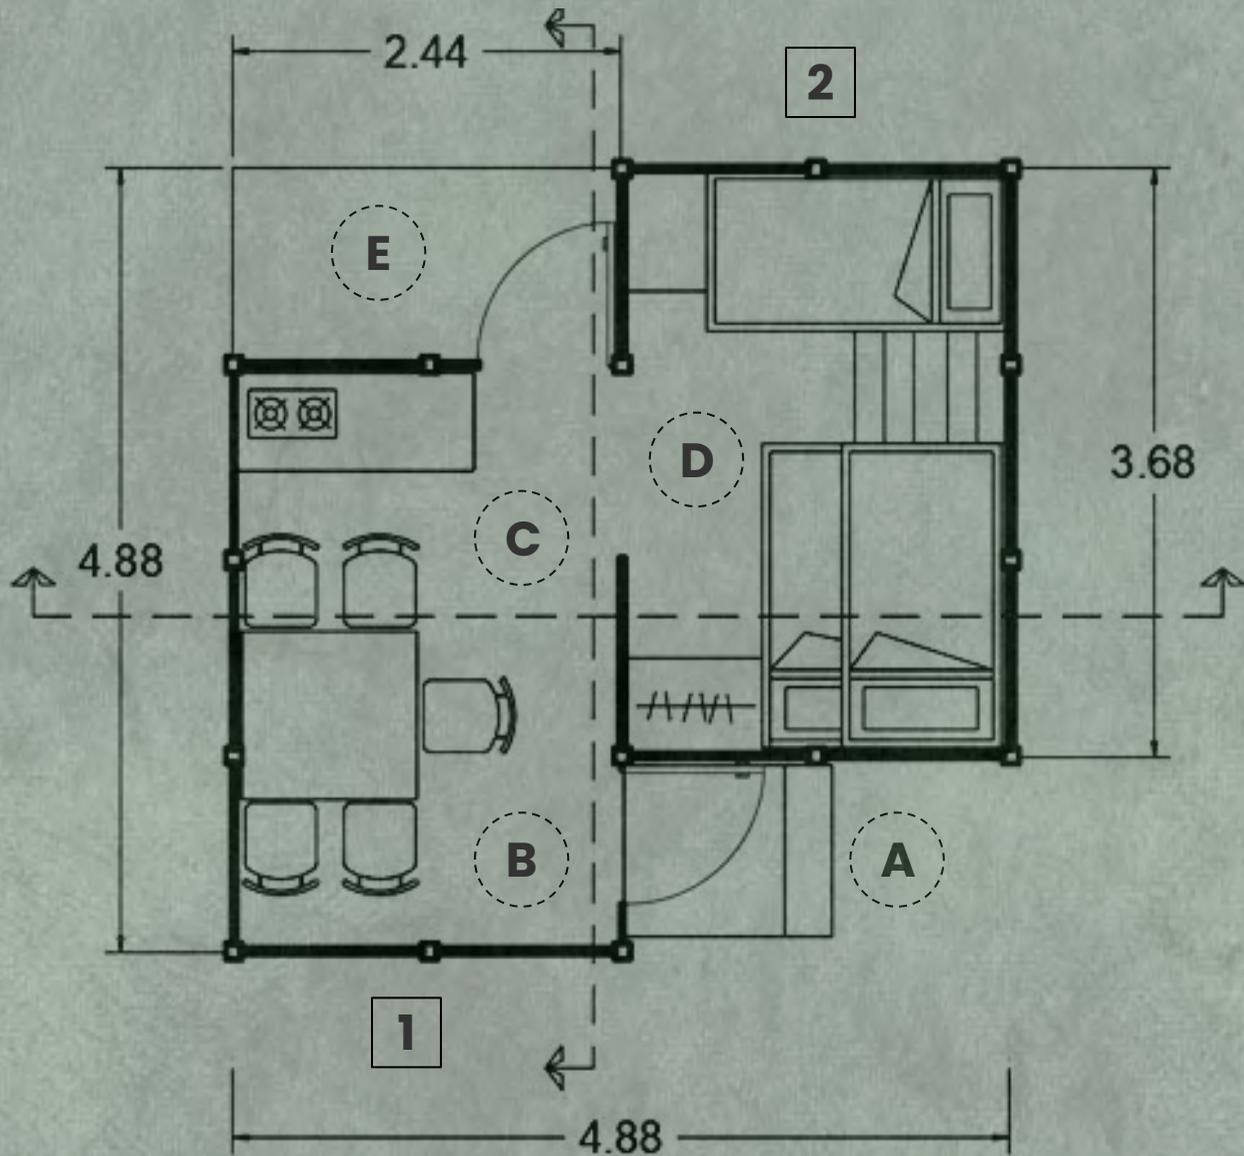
" Propuesta en planta ". (2018). Elaboración en equipo
